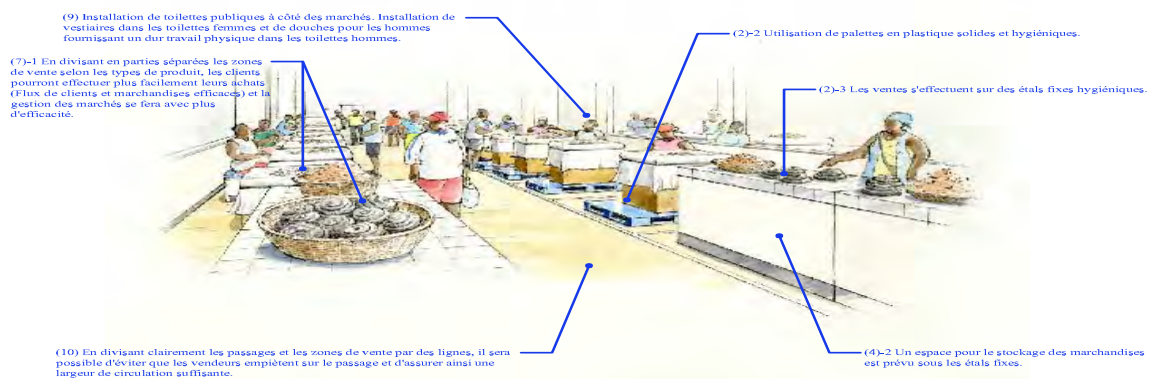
Illustration du plan des installations 2 (marché aux poissons fumés)
